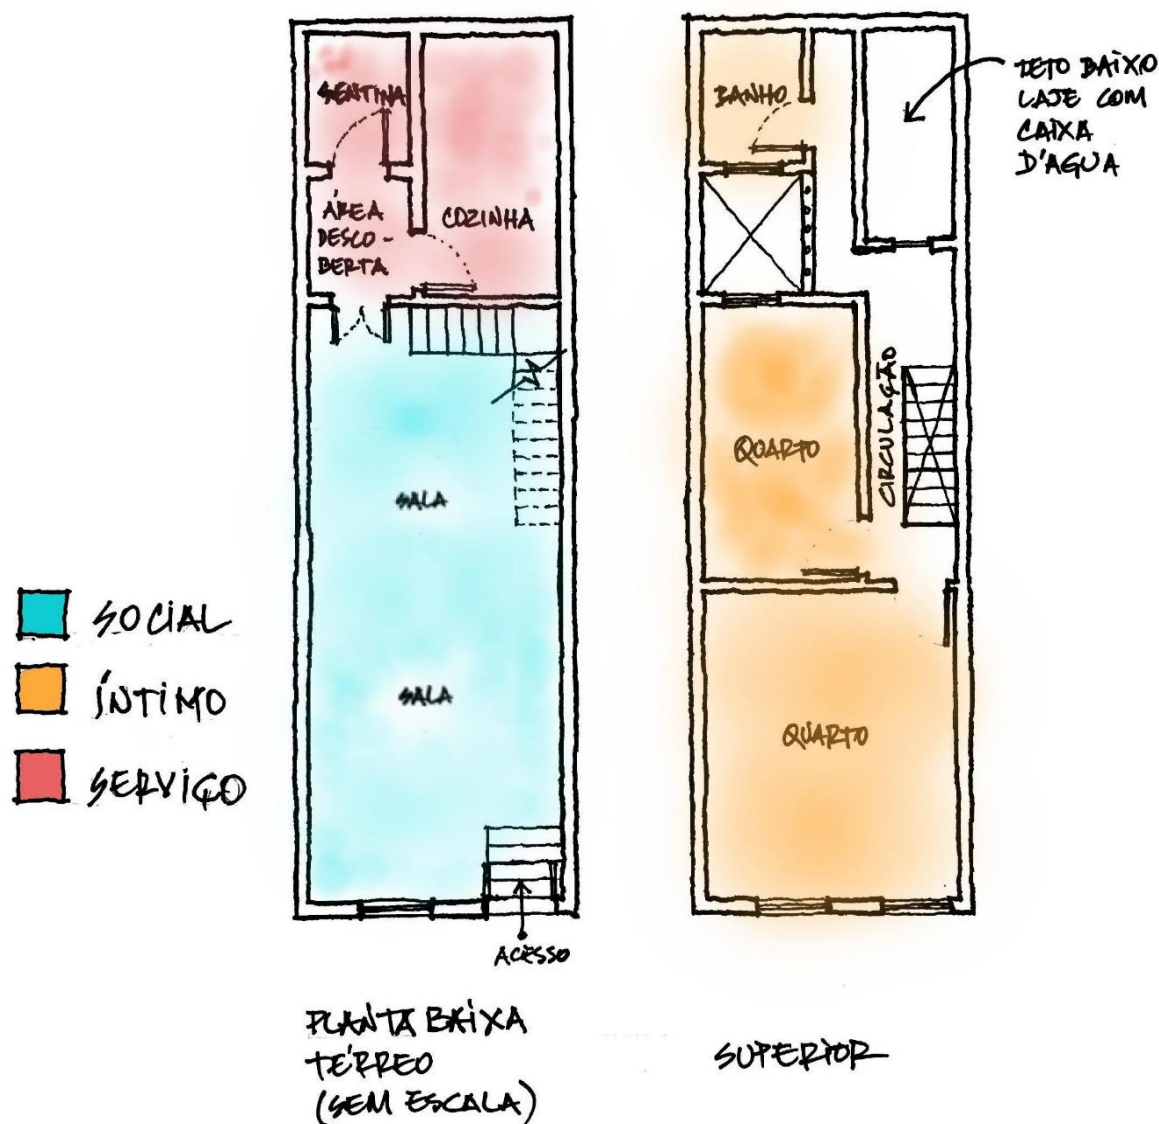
Croqui esquemático da plantas-tipo dos pavimentos térreo e superior da Vila Resende.
